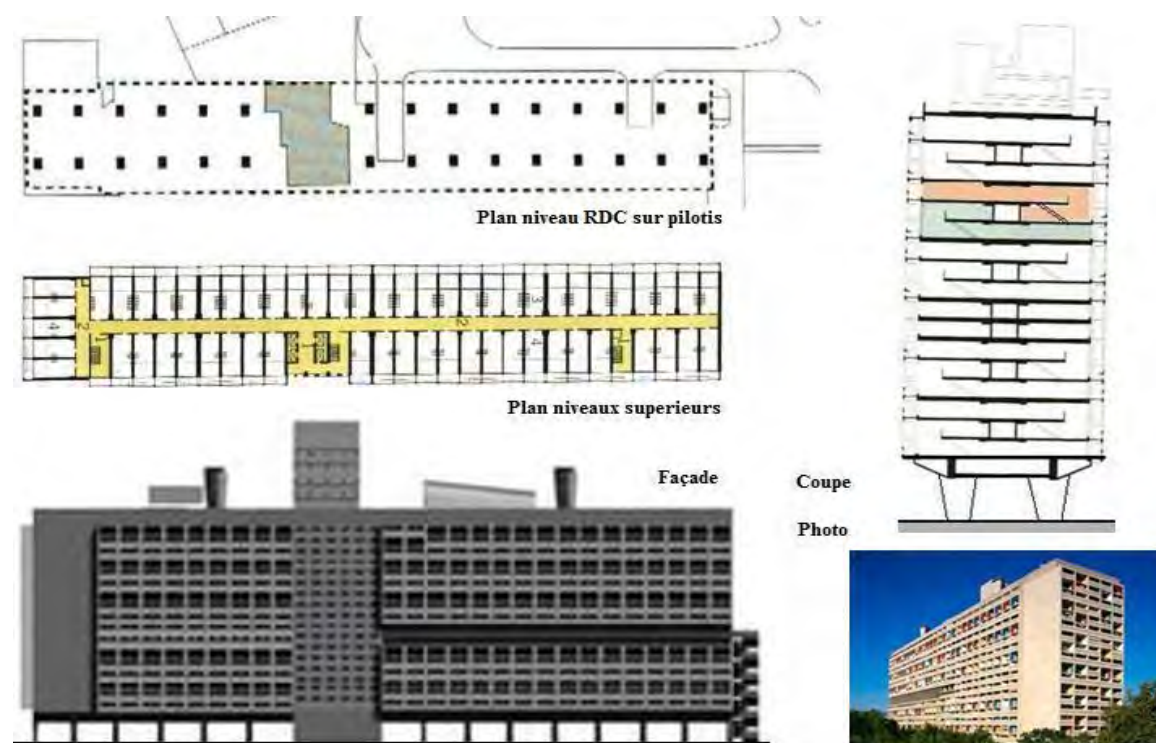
Plans, coupe, façade et photo de l'unité d'habitation de Marseille.
